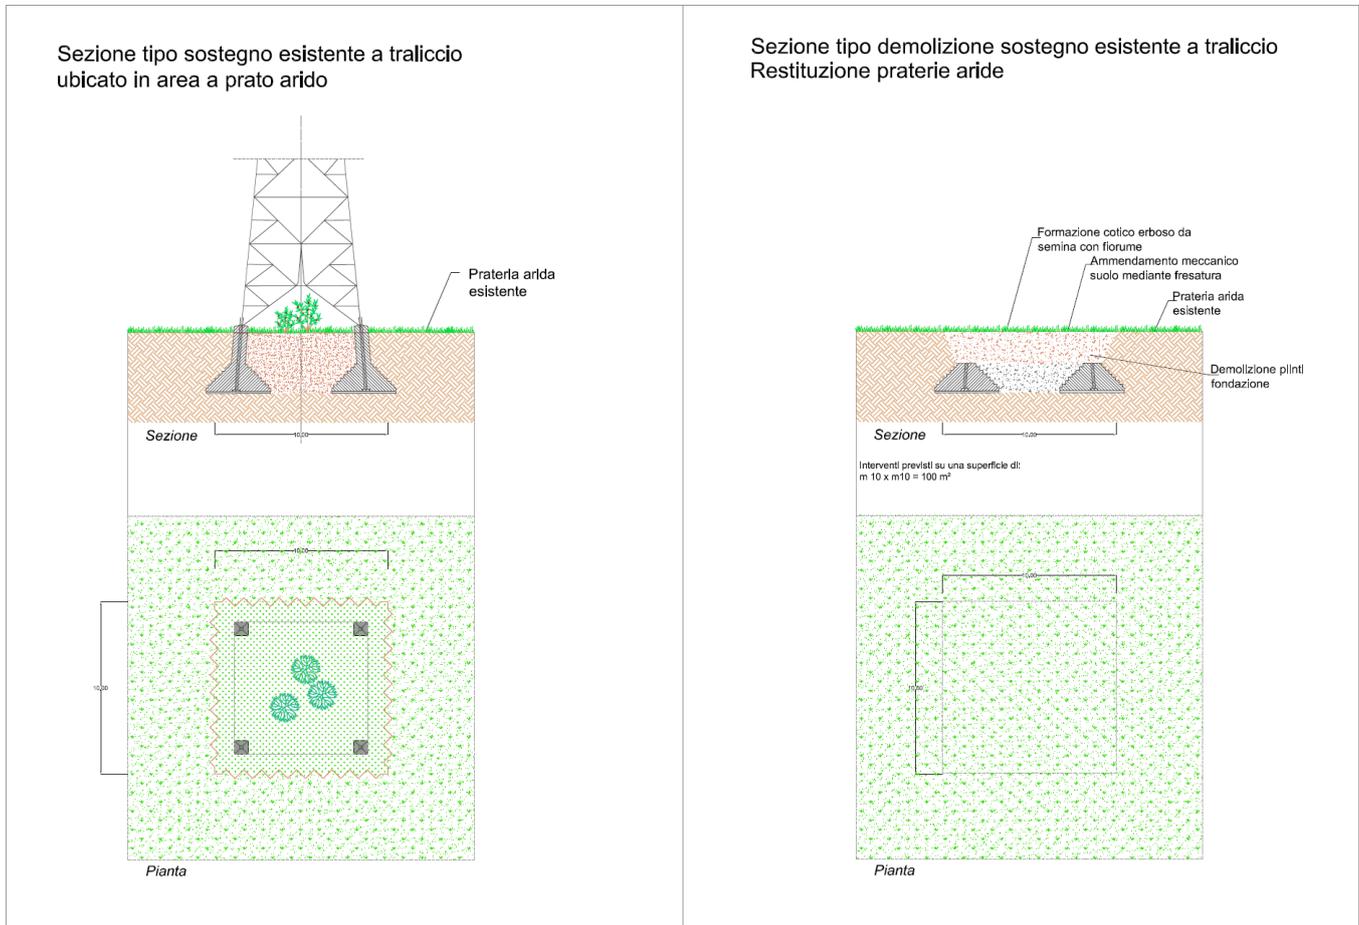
Sezione tipo e pianta Intervento Restituzione praterie aride
